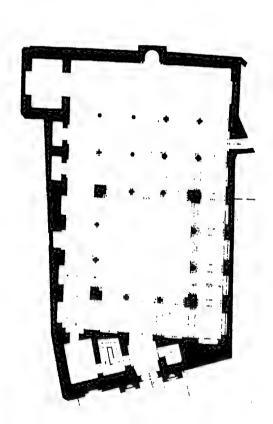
أ ـ مسقط أفقى لجامع الحاكم بأمر الله
